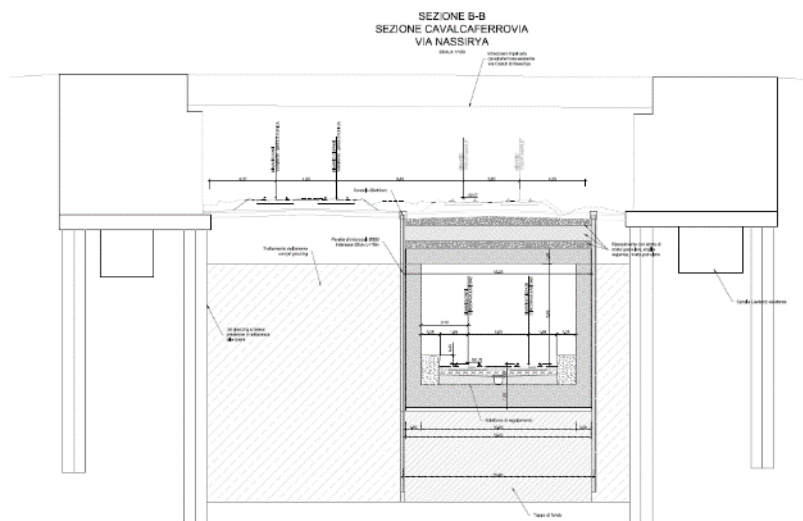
Sezione B Cavalcaferrovia via Nassiriya
